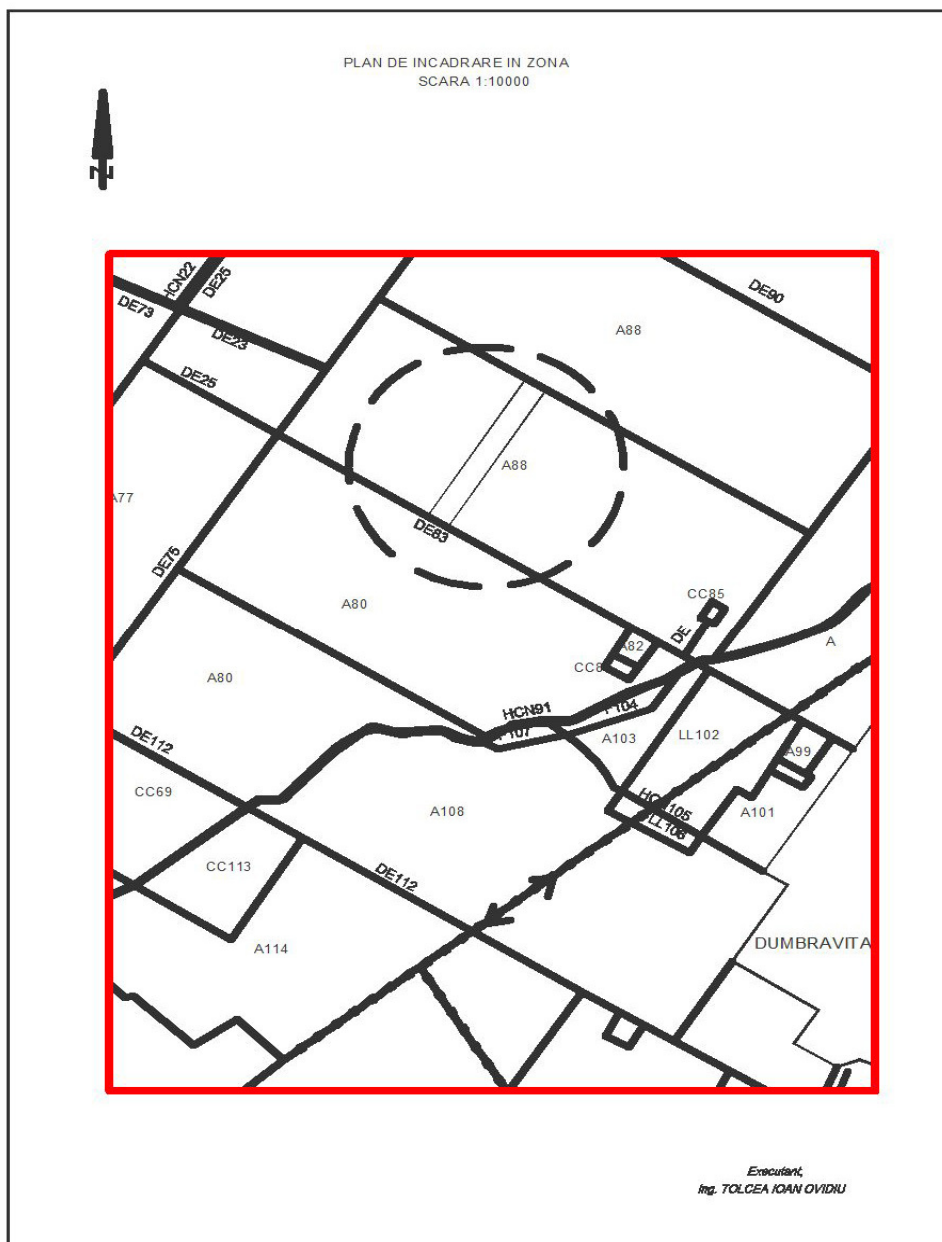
Plan de încadrare în zonă a parcelei. Scara 1:10.000.
